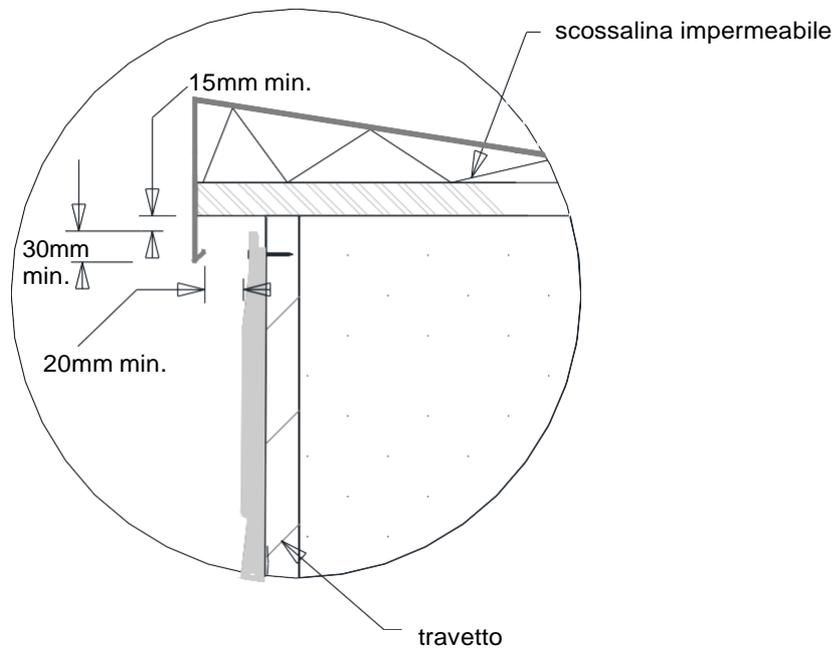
Profilo di arresto su acroterio - Posa diretta
